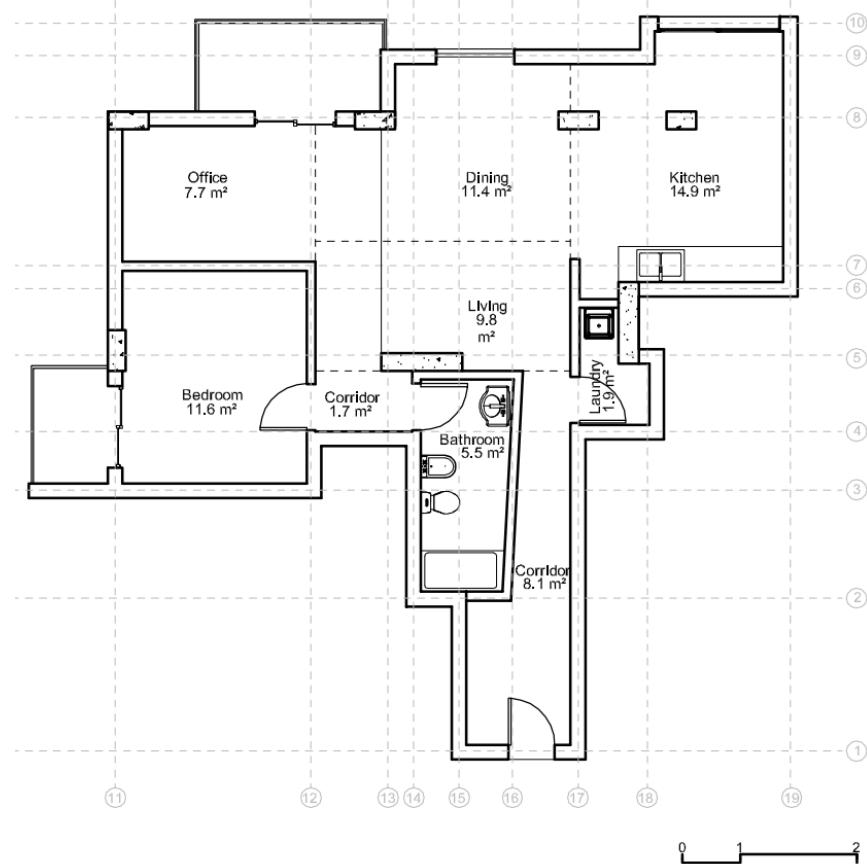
Planta baixa Odivelas após reforma no Revit.
